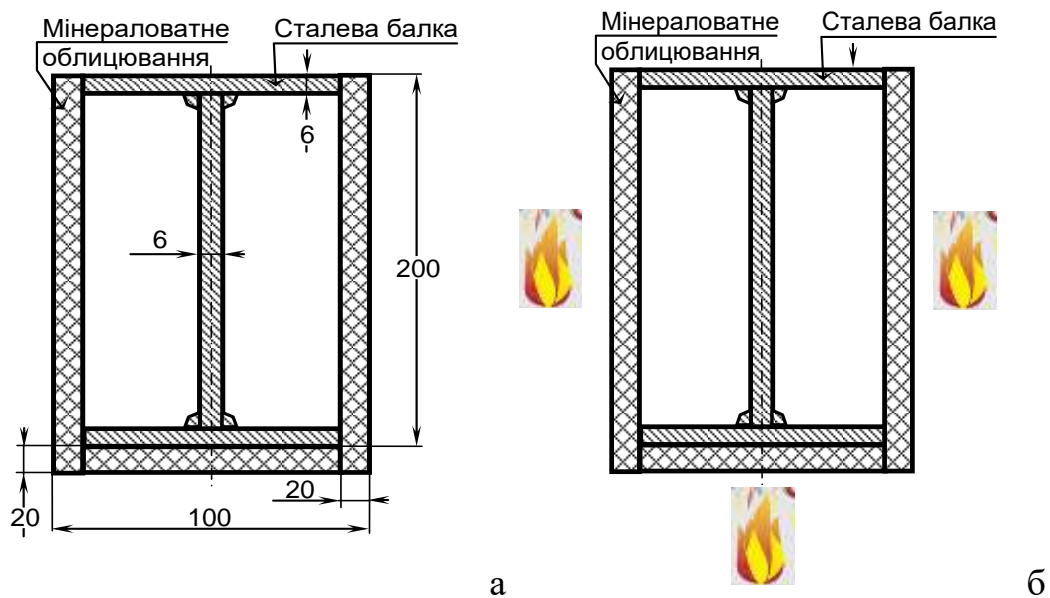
Геометрична схема перерізу сталеві балки із мінераловатним вогнезахисним облицюванням (а) та схема теплового впливу пожежі на переріз балки
